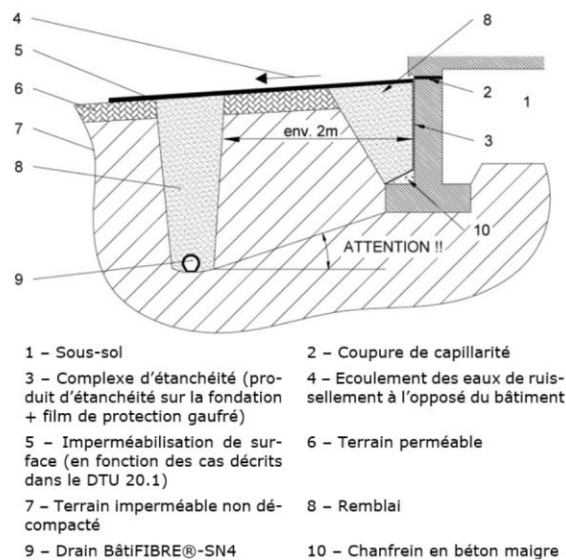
Coupe d'un drainage périphérique éloigné des fondations
